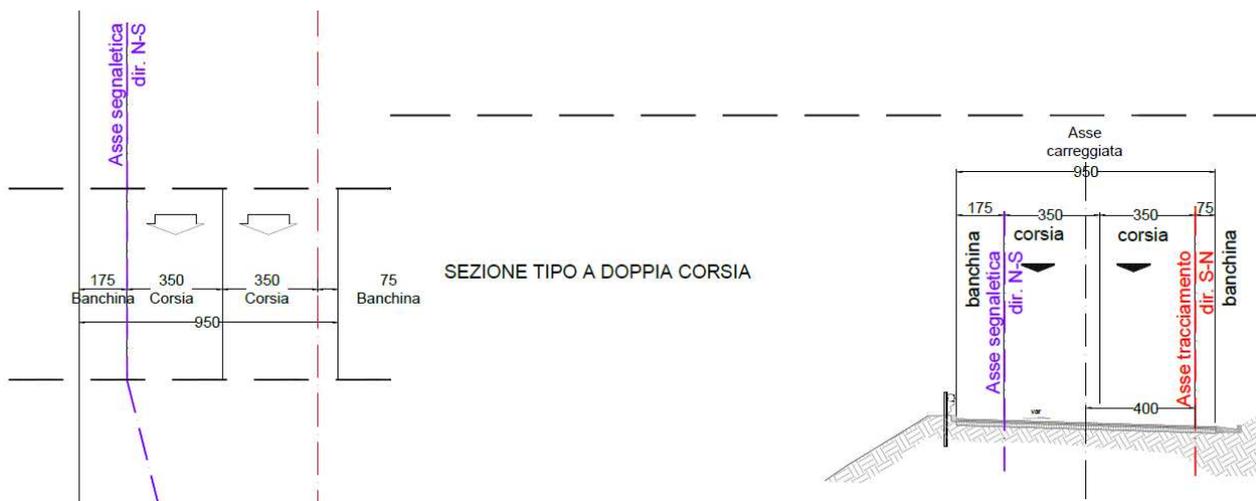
Schema planimetrico e sezione stradale per i tratti all’aperto a doppia corsia
